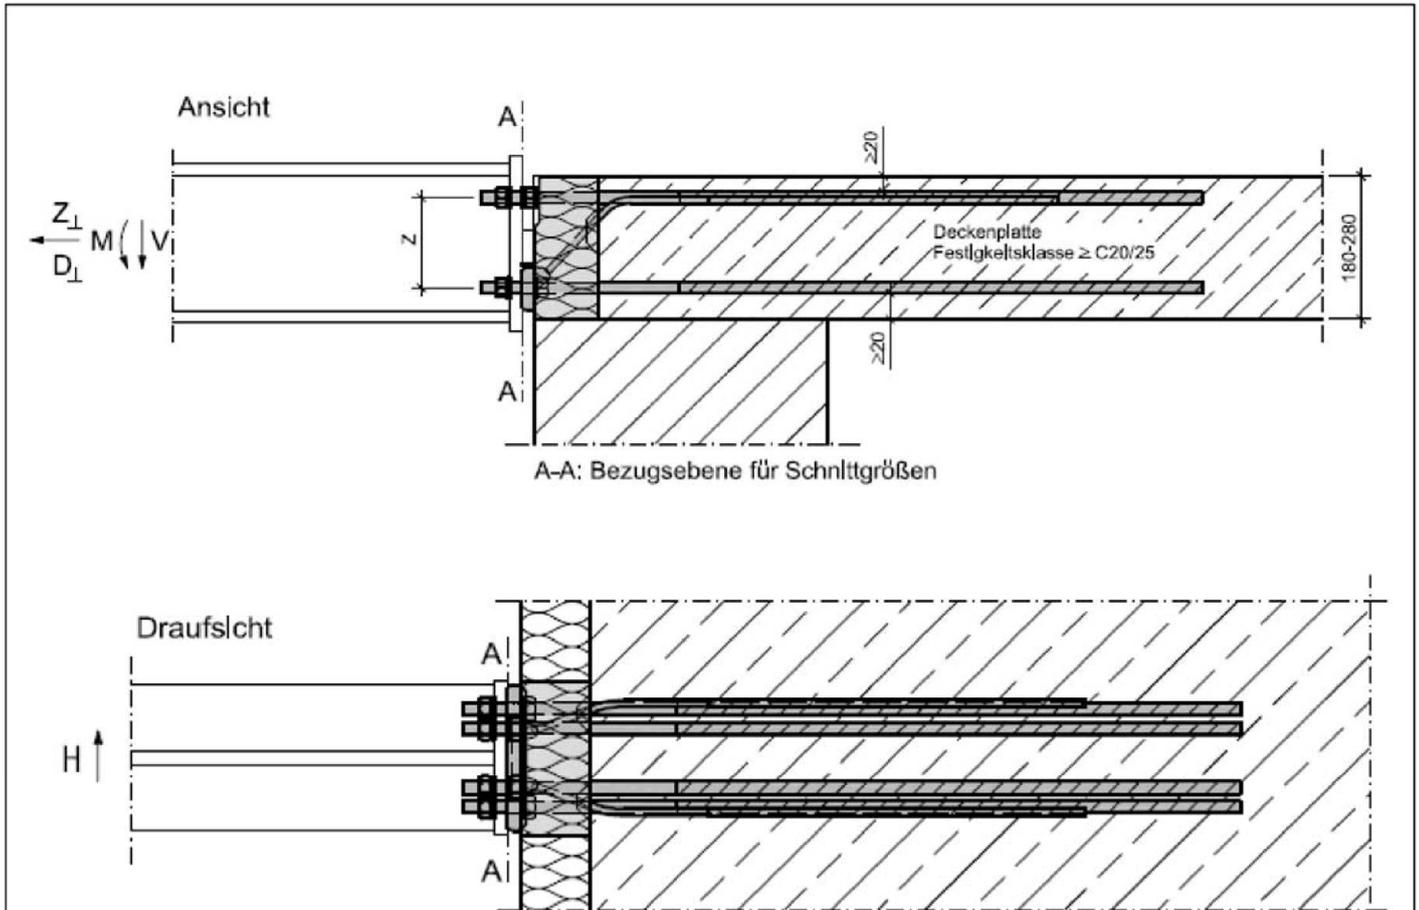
und 56: Schöck Isokorb® XT Typ SK-MM1-VV1, Schnittgrößendefinition
